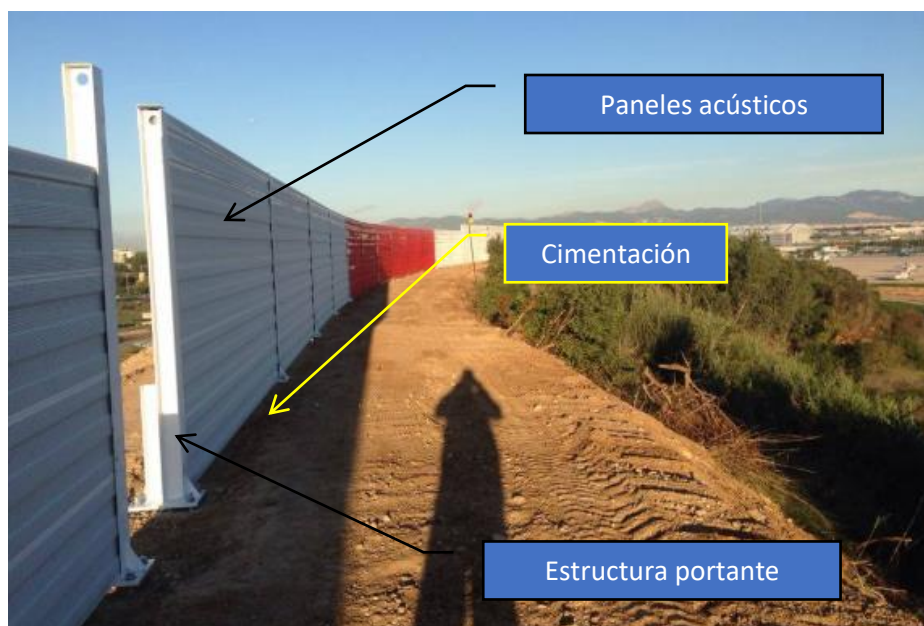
Partes de una pantalla acústica. Fuente: www.metalesa.com
